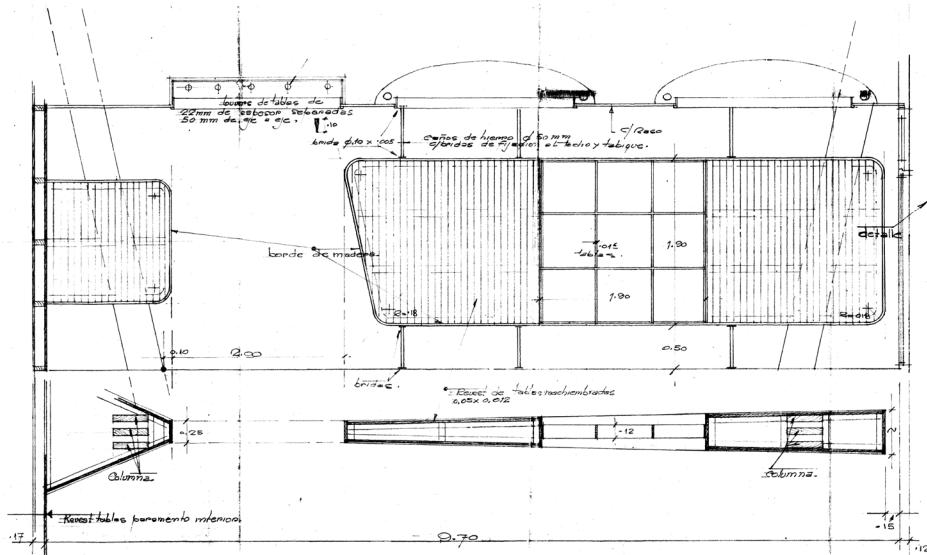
Detalle de columnas soporte, maquetas y carteles. Fuente: Archivo CeDIAP-AABE.
